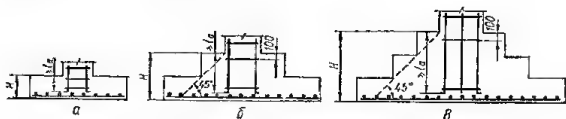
Отдельные монолитные фундаменты под колонны:
